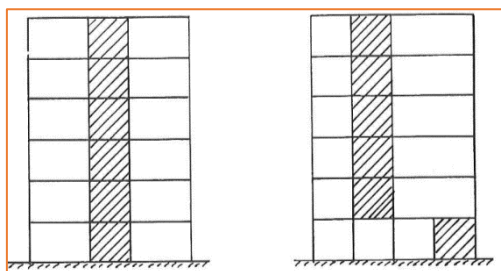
USTABIL PLASSERING AV VERTIKALE SKIVER [1]
